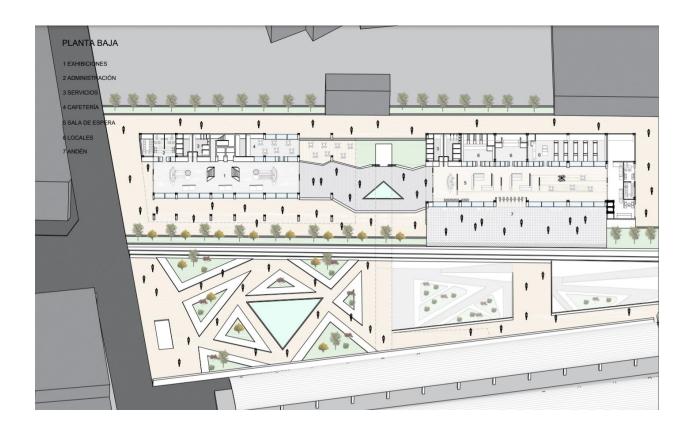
Planta baja en perspectiva 0-90 grados. Elaboración propia
